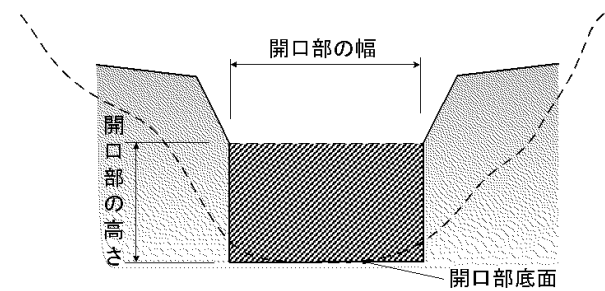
透過型砂防堰堤の開口部(斜線部) (土流設 p26)
